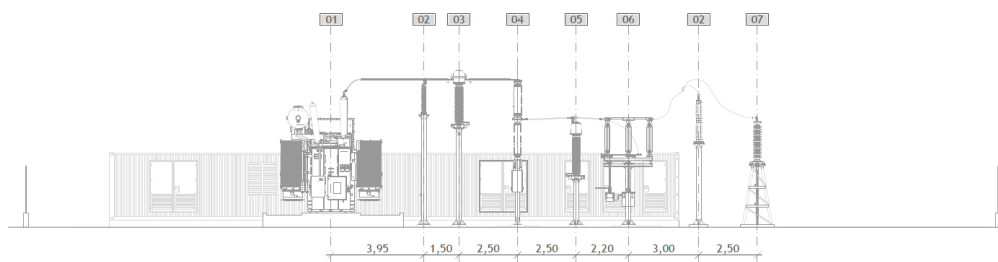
Sezione Elettromeccaniche-Sezione A-A
